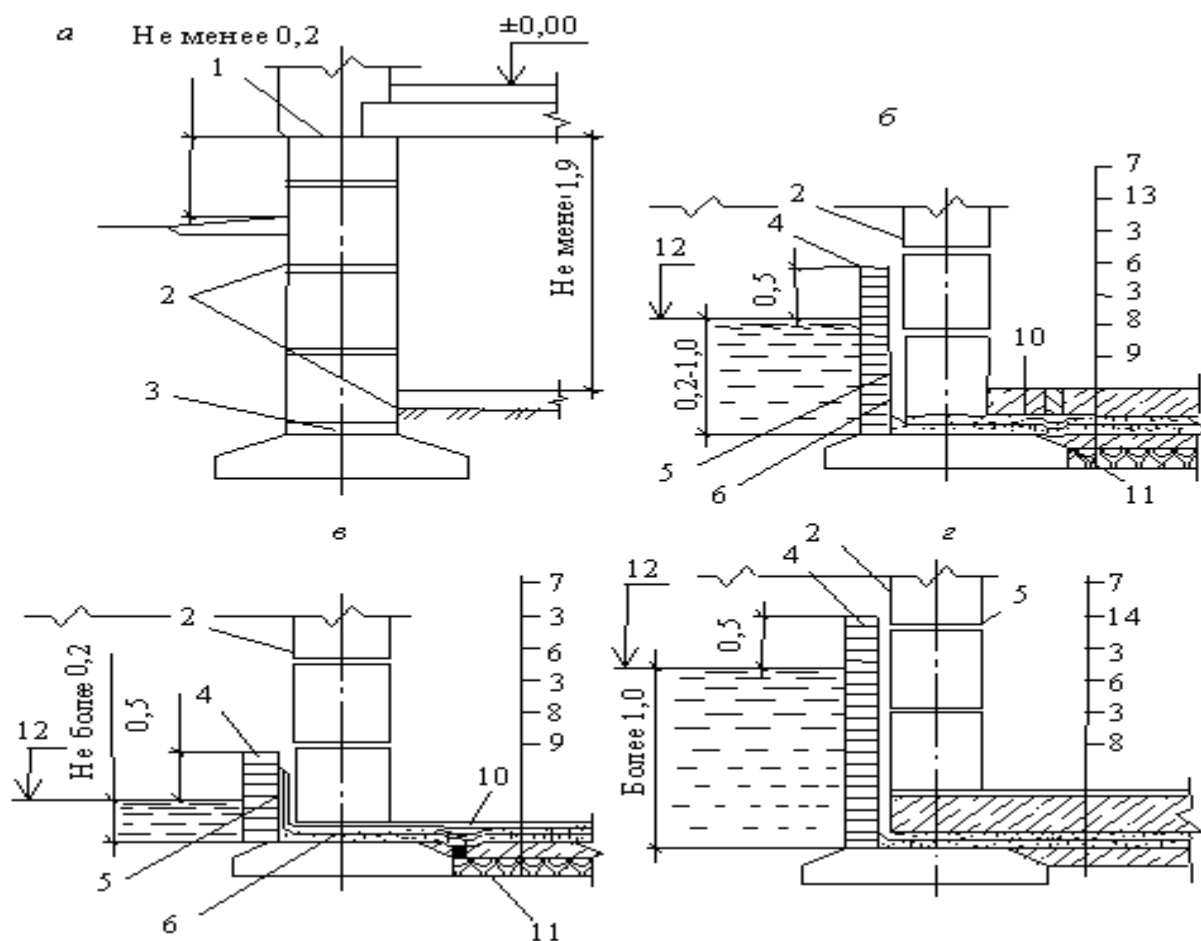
Гидроизоляция ленточных фундаментов: а – при уровне подземных вод ниже подошвы фундамента; б – при напоре подземных вод 200...1000 мм; в – при напоре подземных вод до 200 мм; г – при напоре подземных вод свыше 1000 мм; 1 – два слоя толя или гидроизола на битумной мастике; 2 – окраска горячим битумом за два раза; 3 – цементная стяжка из раствора состава 1:2 толщиной 20...30 мм; 4 – защитная стяжка из красного кирпича; 5 – затирка цементным раствором; 6 – оклеечная гидроизоляция; 7 – пол подвала; 8 – бетонная подготовка толщиной 100 мм; 9 – жирная мятая глина; 10 – стеклоткань; 11 – деформационный шов, заполняемый битумом; 12 – расчетный уровень подземных вод; 13 – пригрузочный слой бетона (толщина по расчету); 14 – железобетонная плита (толщина по расчету)
